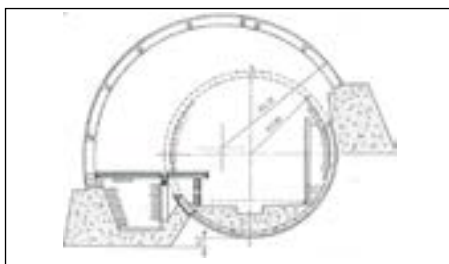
Поперечное сечение бокового тоннеля. Кабели проложены за металлоконструкцией
